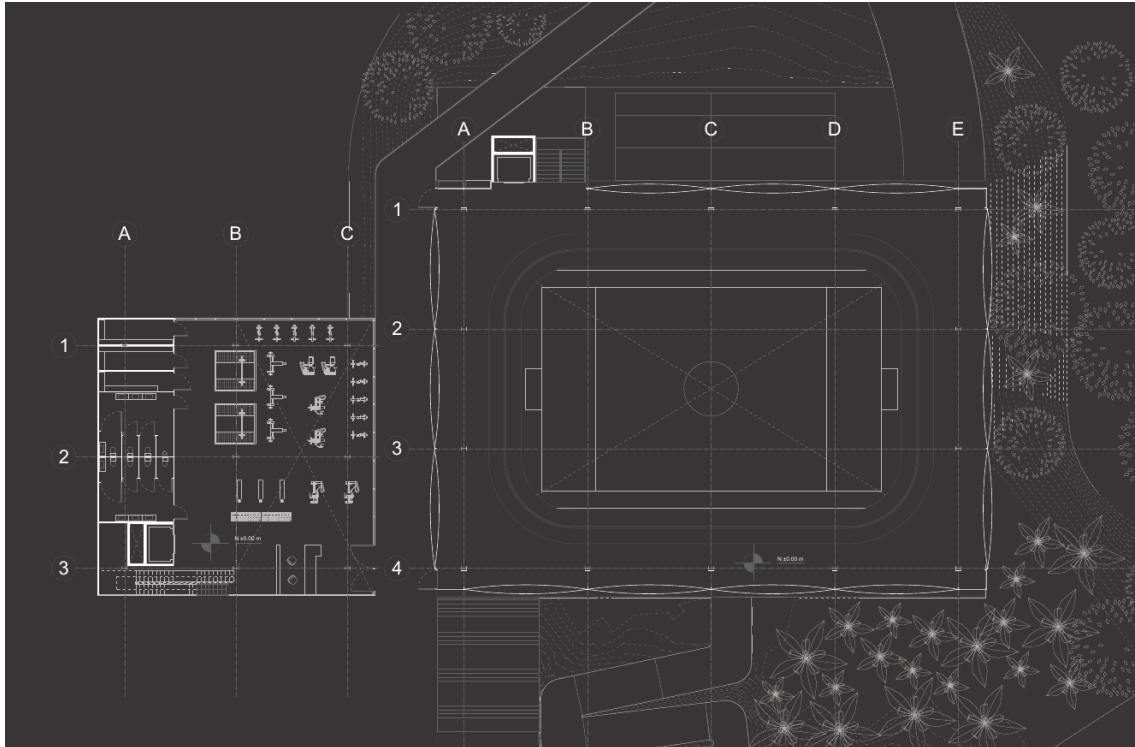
Planta nivel ± 0.00 Bloques deportivos, Fuente elaboración propia
